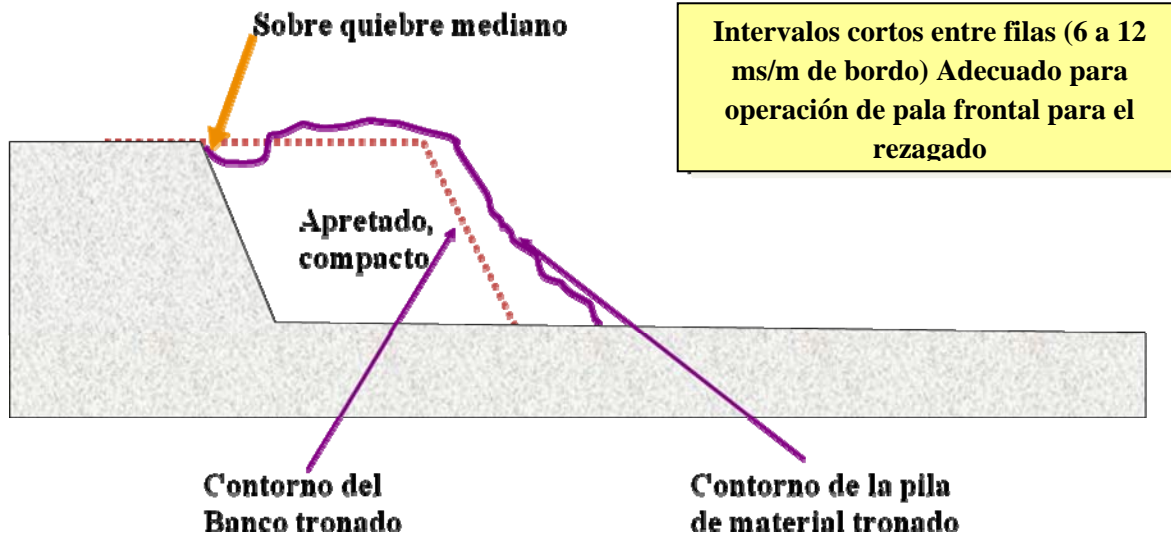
Esquema con 6 ms/m a 12 ms/m de retardo entre filas de barrenos
